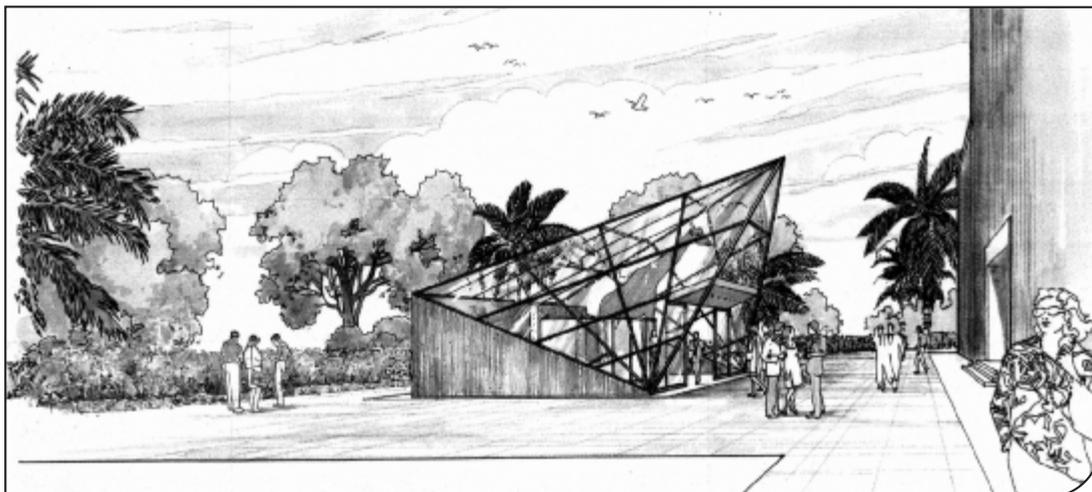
Vista prospettica del caveau di Roma in adiacenza al muro del Museo.
